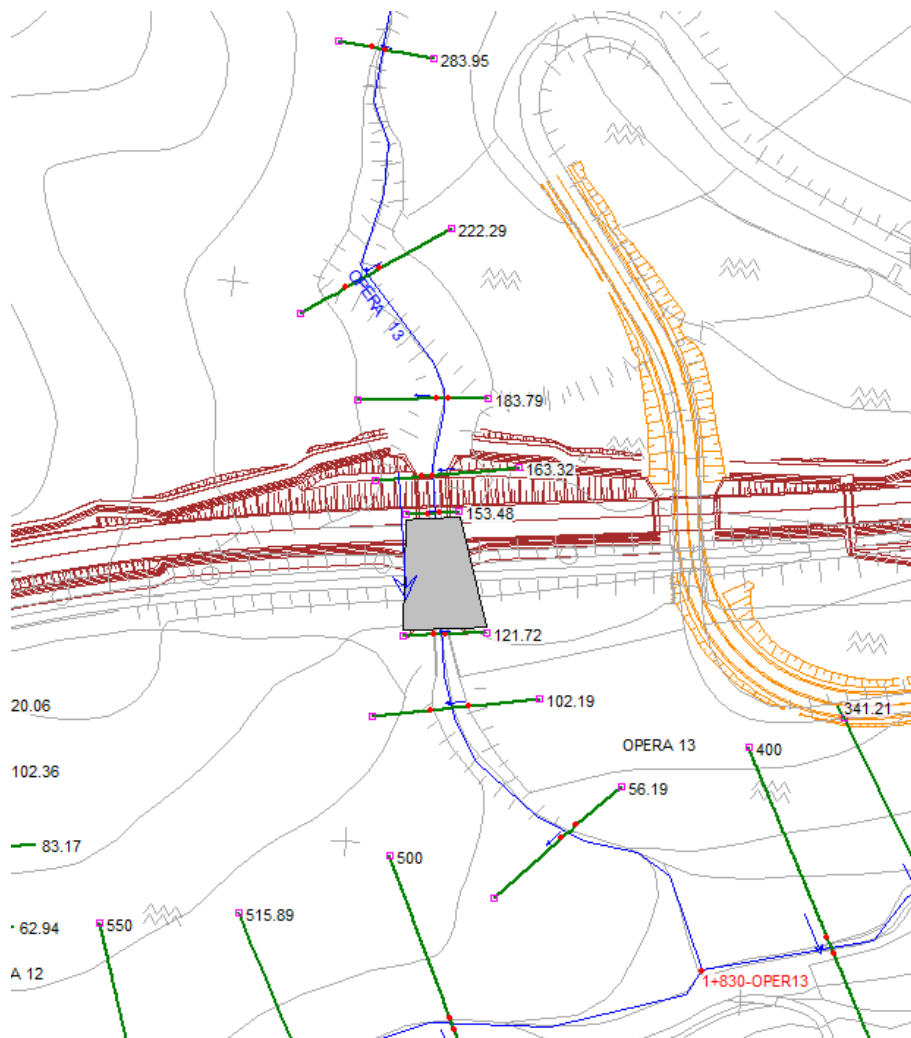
Planimetria Hec ras – sovrapposizione SDF – linea di progetto
